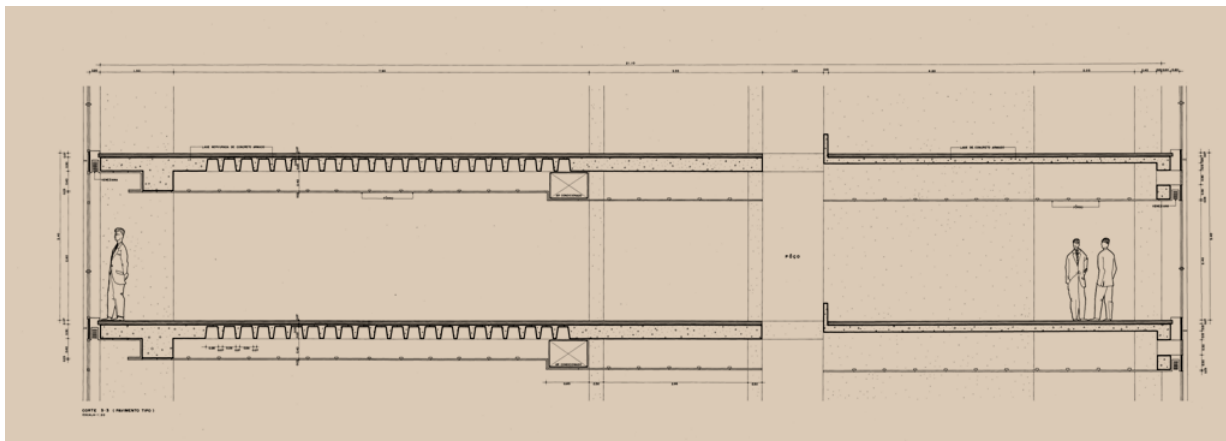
Corte esquemático da estrutura do pavimento tipo do Sede I. Fonte: Arquivo digital nosso sobre original do autor do projeto.
